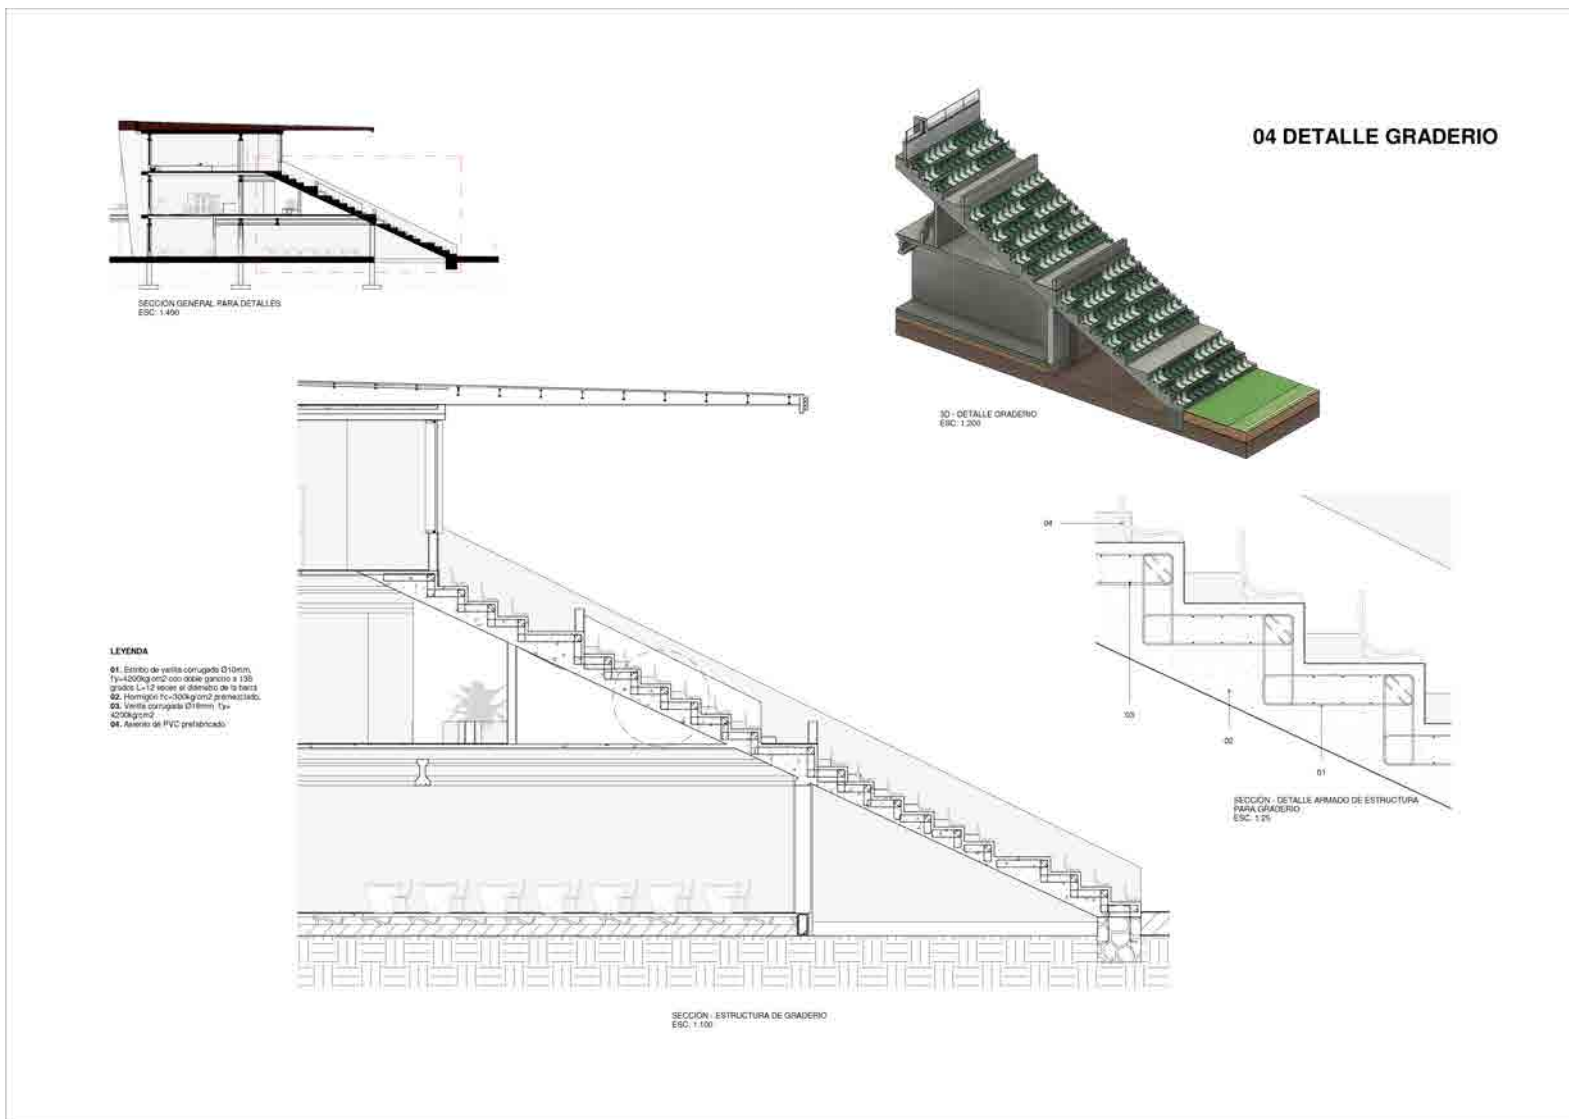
Detalle graderío. Elaboración: Autores.
